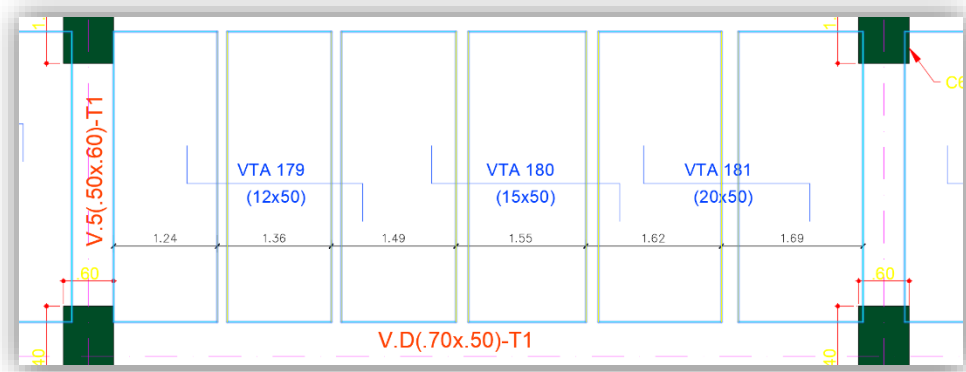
Zoom Planta estructural PISO 15-22 (MARVAL, 2019)
